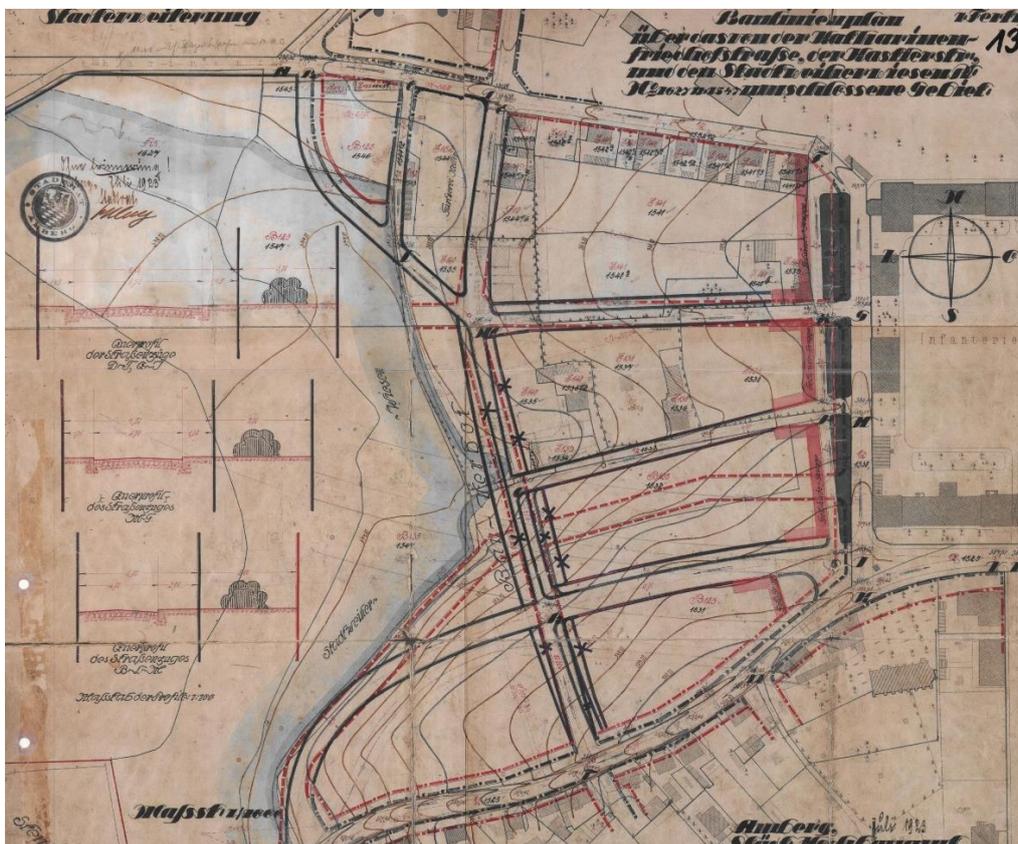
Baulinienplan 13 „Nürnberger Straße – Ost/ Infanteriestraße“
